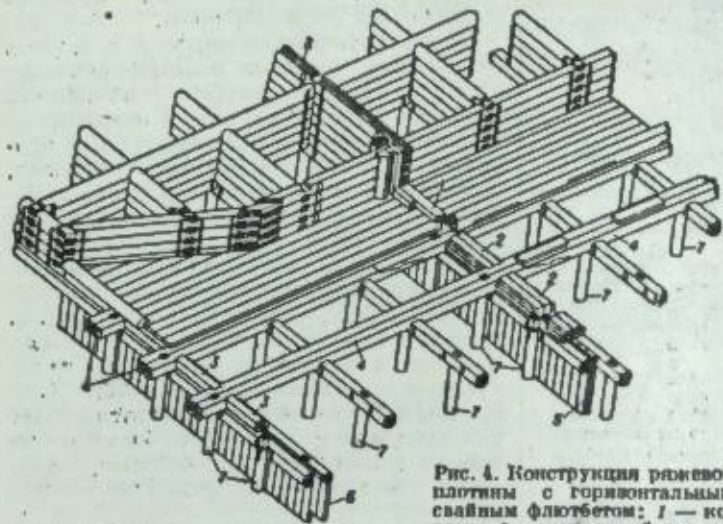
Конструкция рязжевой плотины с горизонтальным свайным флотбетом: 1 — король; 2 — королевый шапочный брус; 3 — понурный шапочный брус; 4 — продольный связующий брус; 5 — королевый шпунт; 6 — понурный шпунт; 7 — одиночные сваи; 8 — шпунтованный простенок устоя.
